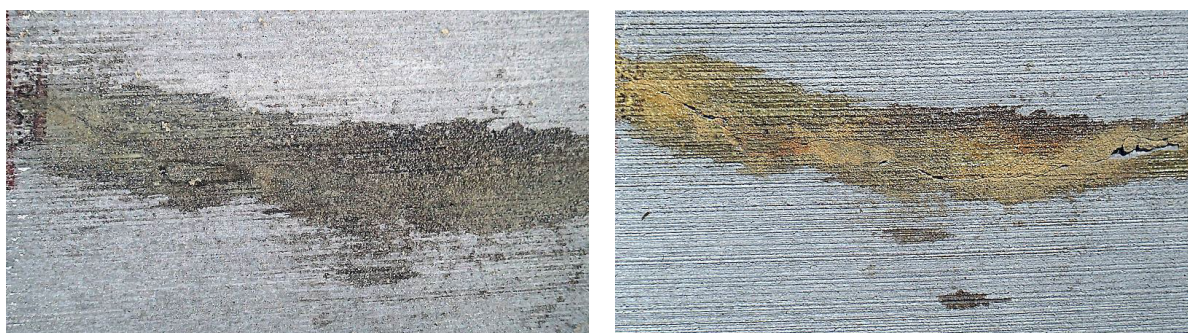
模擬横断ひび割れ箇所の外観変状
